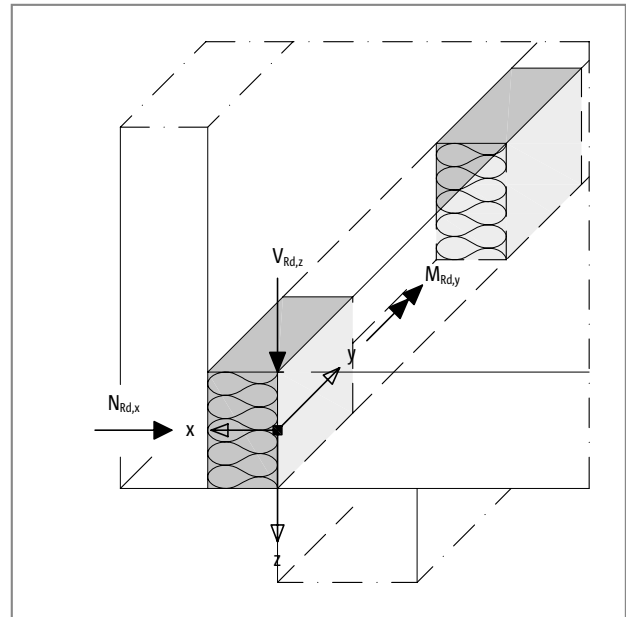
Schöck Isokorb® tipo ABXT: regola dei segni per il calcolo dei parapetti anteposti
